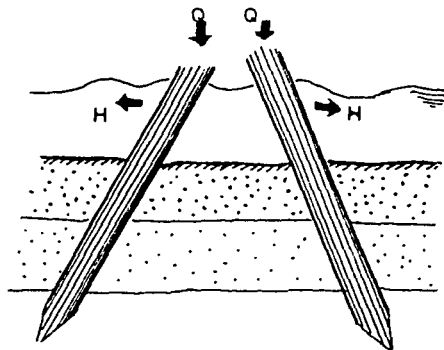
PILOTES INCLINADOS CON CARGA HORIZONTAL
